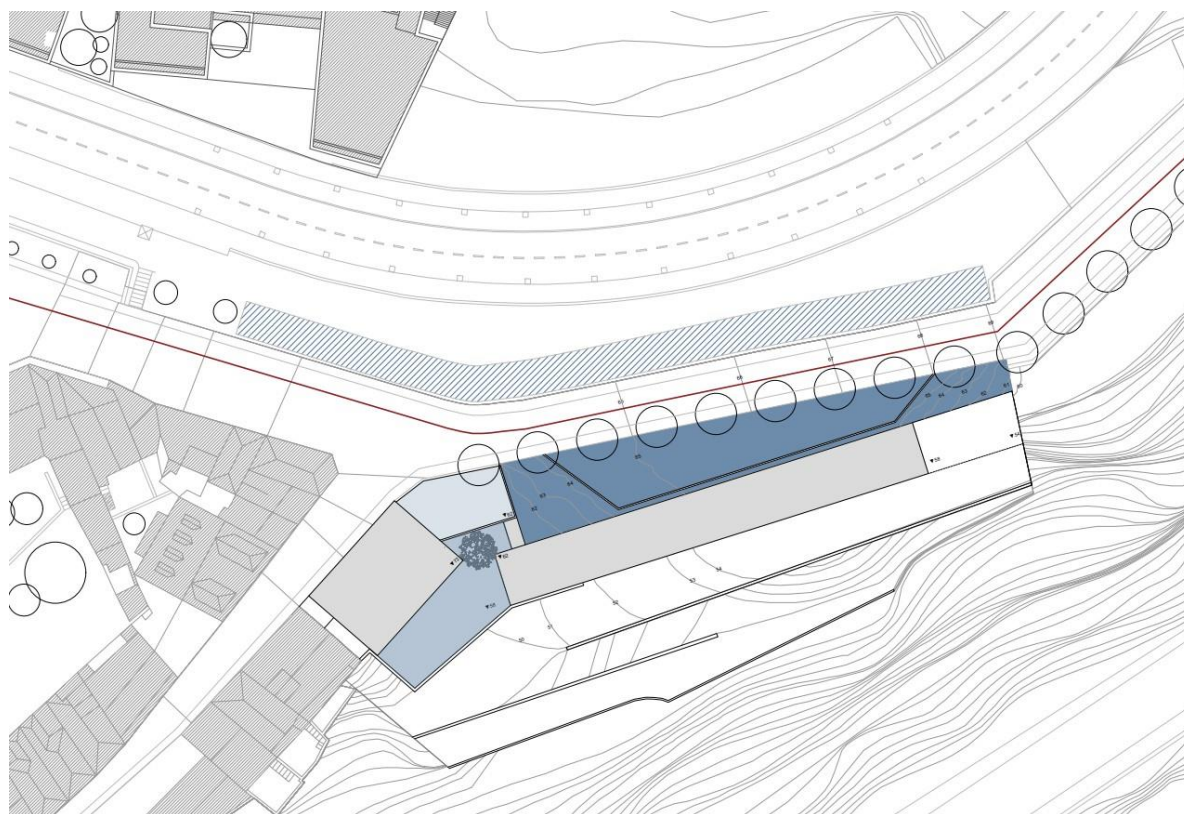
Planta esquemática dos espaços exteriores do Projeto V (Fonte: Autor)
